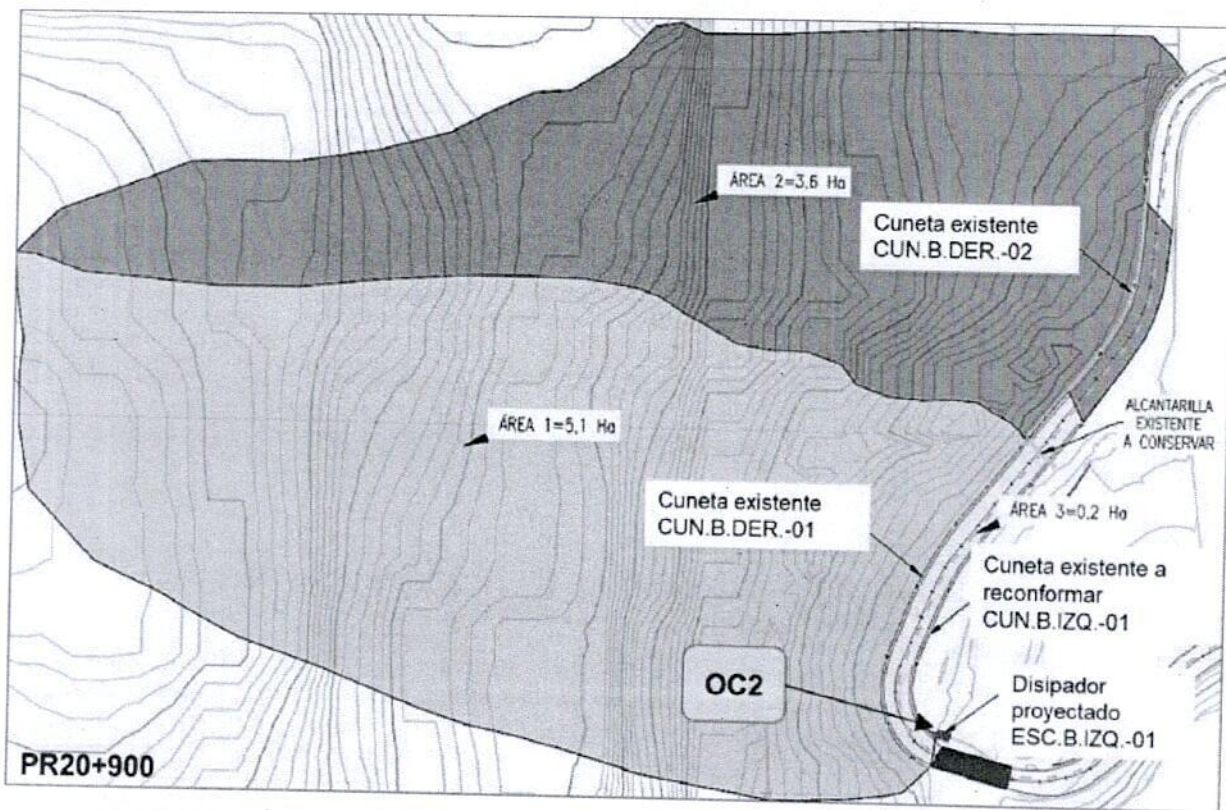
Áreas de drenaje obras del sistema vial - sector río Verde PR20+900
